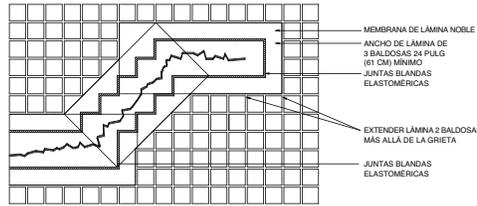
COLOCACIÓN DE LÁMINAS Y PLANO DE JUNTAS BLANDAS PARA GRIETAS MÚLTIPLES O ENTRELAZADAS
